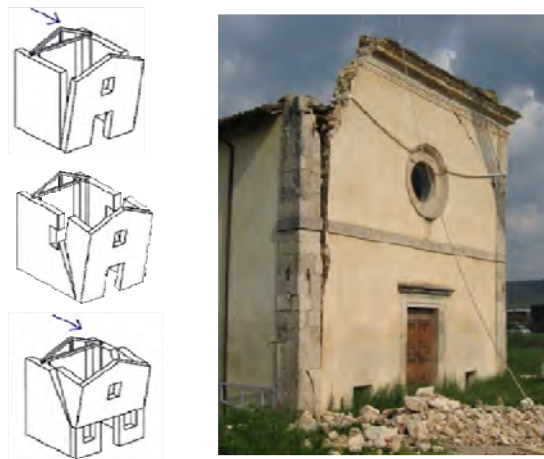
Mecanismo 1 – Rotação da fachada para fora do plano - Igreja na região de L'Aquila
